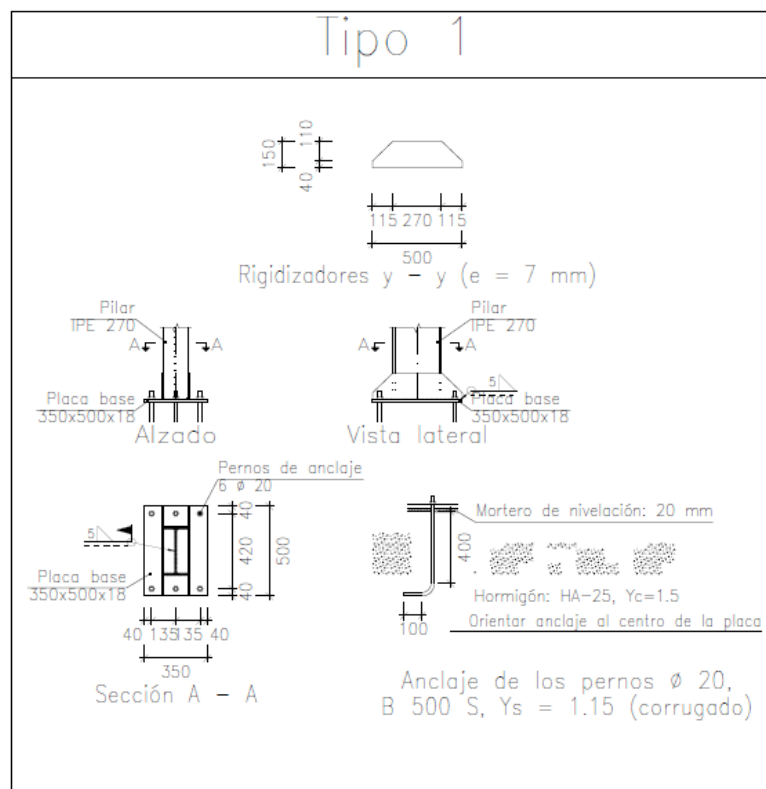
Detalle placa de anclaje tipo 1. Fuente: Elaboración propia a partir de CYPE 3D
